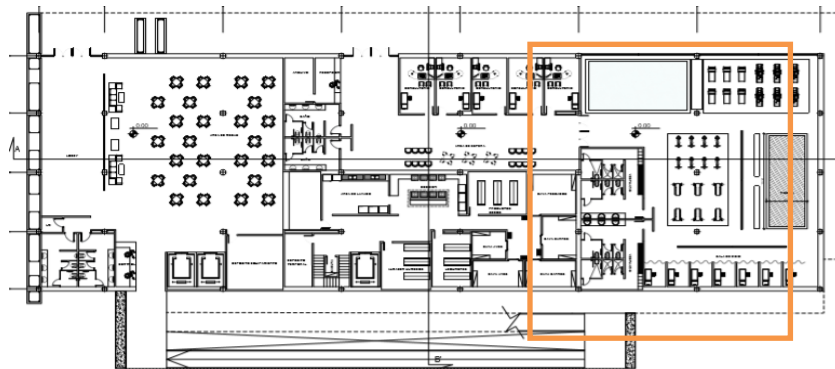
Planta Baja. Gimnasio. Nivel +0,00m. (2020)
